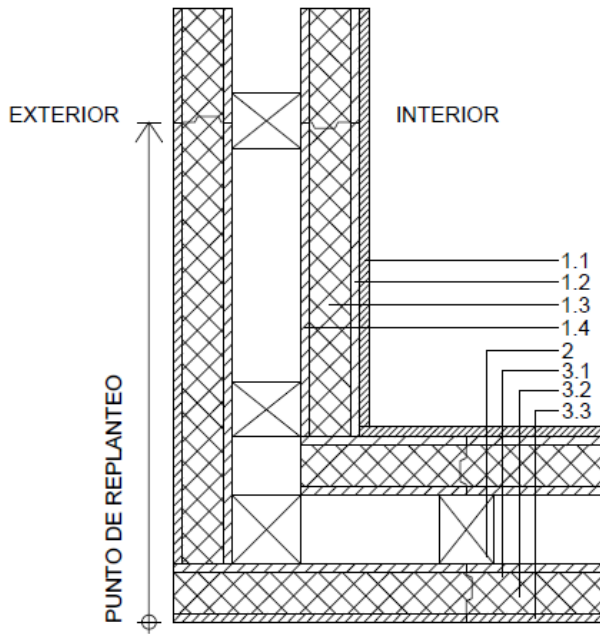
Encuentro tipo de fachada con paneles SATE y WALL con cubierta inclinada. Sección transversal vertical.
